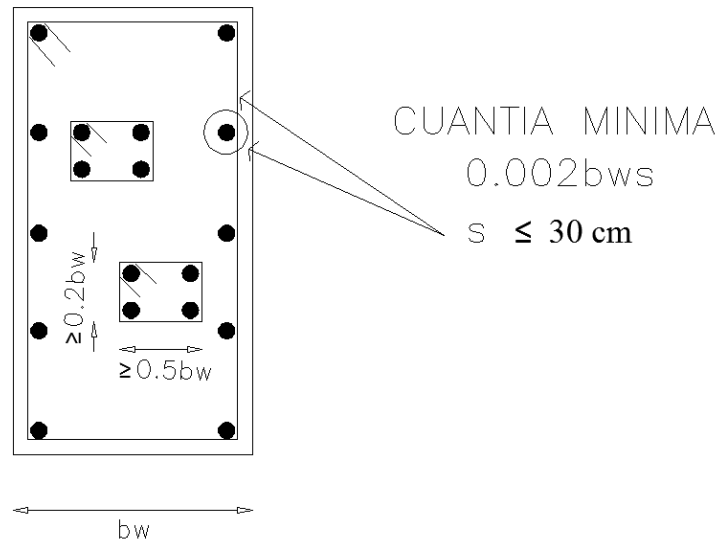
ALTERNATIVA 2 DE ARMADO DE MURO DE CORTE
